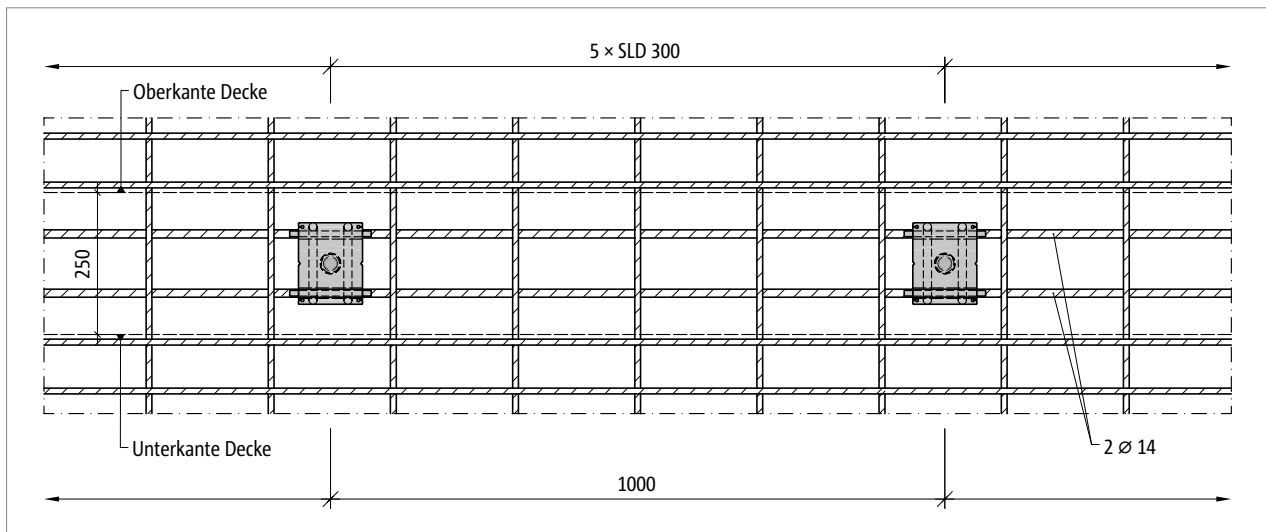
Ansicht der Wand mit Bewehrungsanordnung
